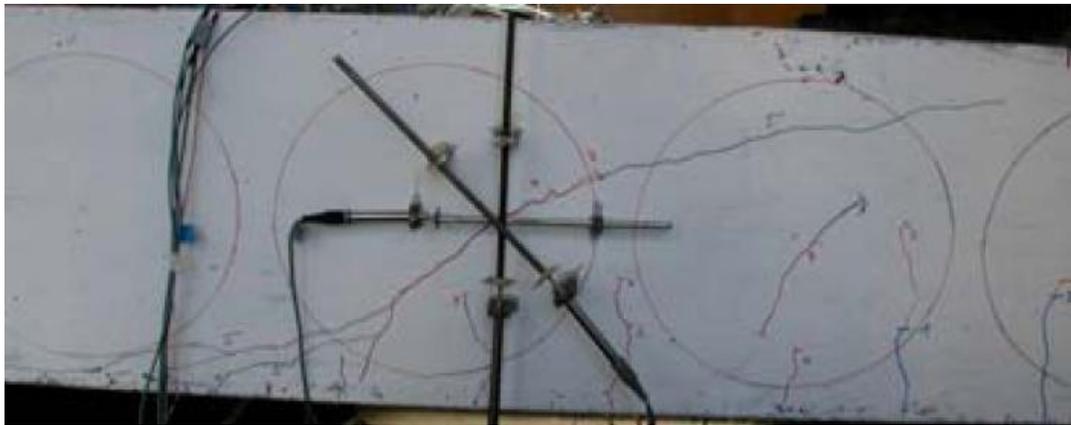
Ruptura por cortante em uma laje *BubbleDeck
